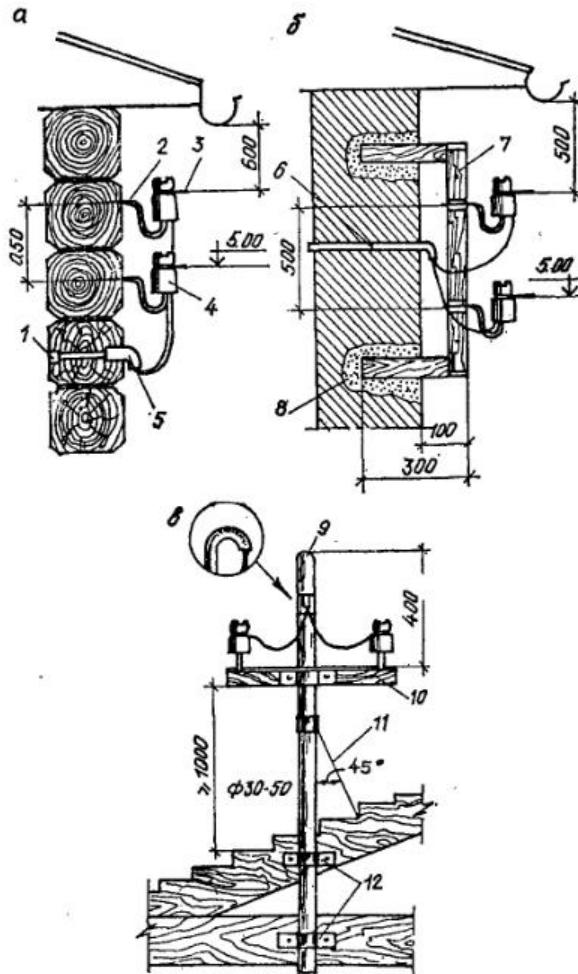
а — для деревянных стен; б — для кирпичных строений; в — для небольших домиков и хозяйственных строений: 1 — выходное отверстие; 2 — крюк; 3 — подводка сети; 4 — изолятор; 5 — входная воронка; 6 — свинцовая или поливинилхлоридная трубка; 7 — кронштейн сварной; 8 — цементный раствор с наполнителем; 9 — труба ввода; 10 — кронштейн; 11 — растяжка; 12 — хомут крепления.
